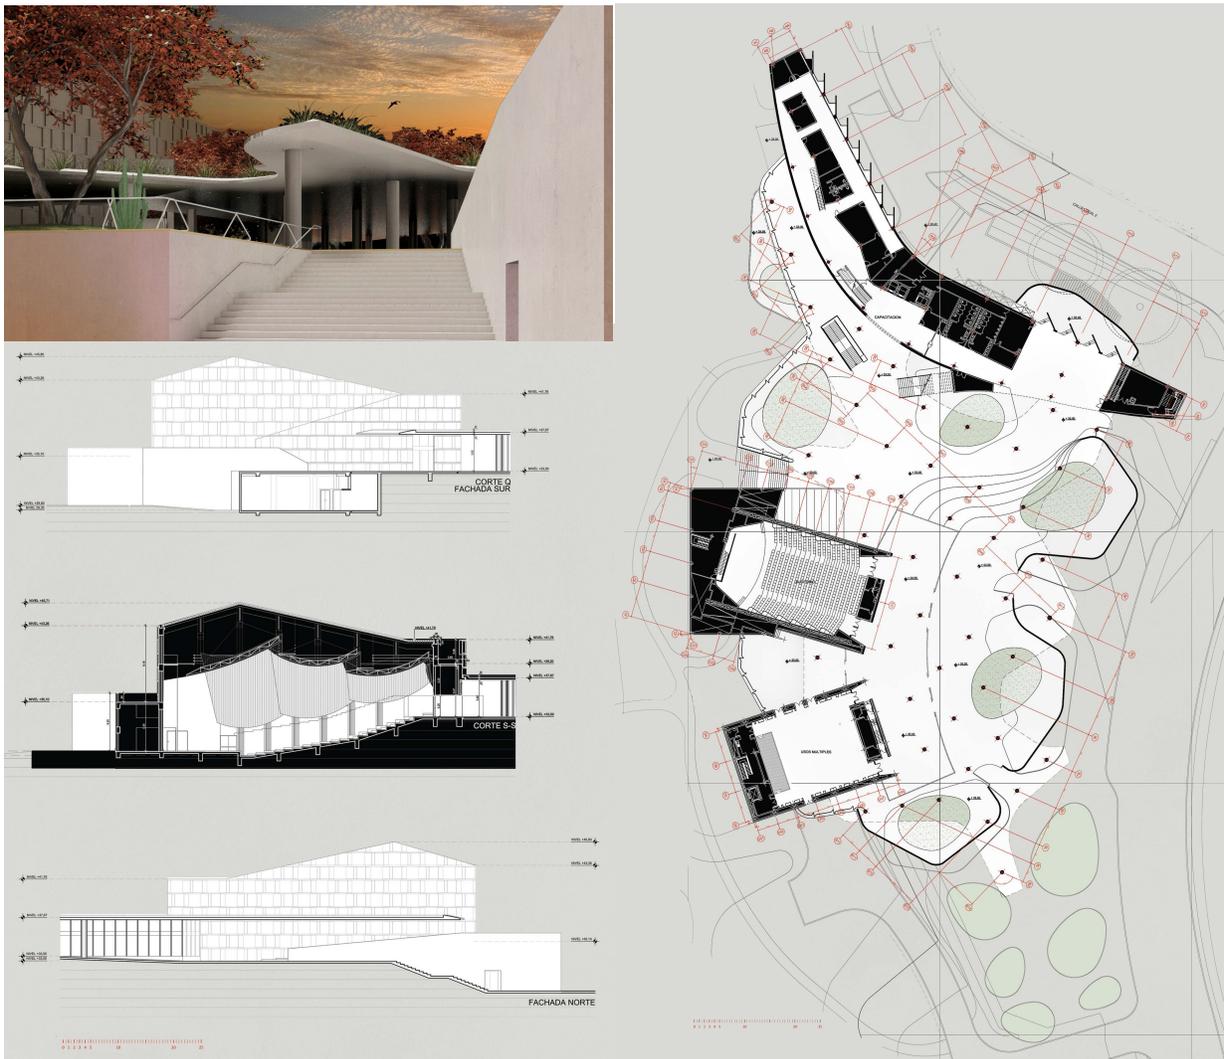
, 112,, 113; Vista acceso ; Secciones y fachadas auditorios; Planta principal CAPET
